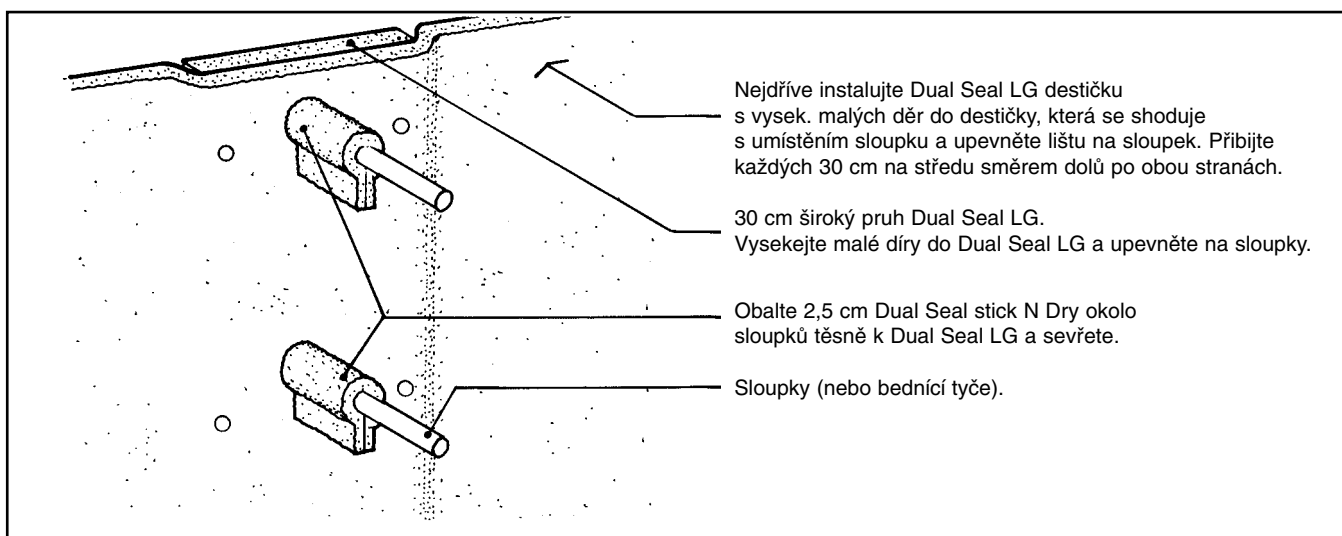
Instalace Dual Seal LG na mezery mezi obkládacími deskami - půdorysný pohled.
